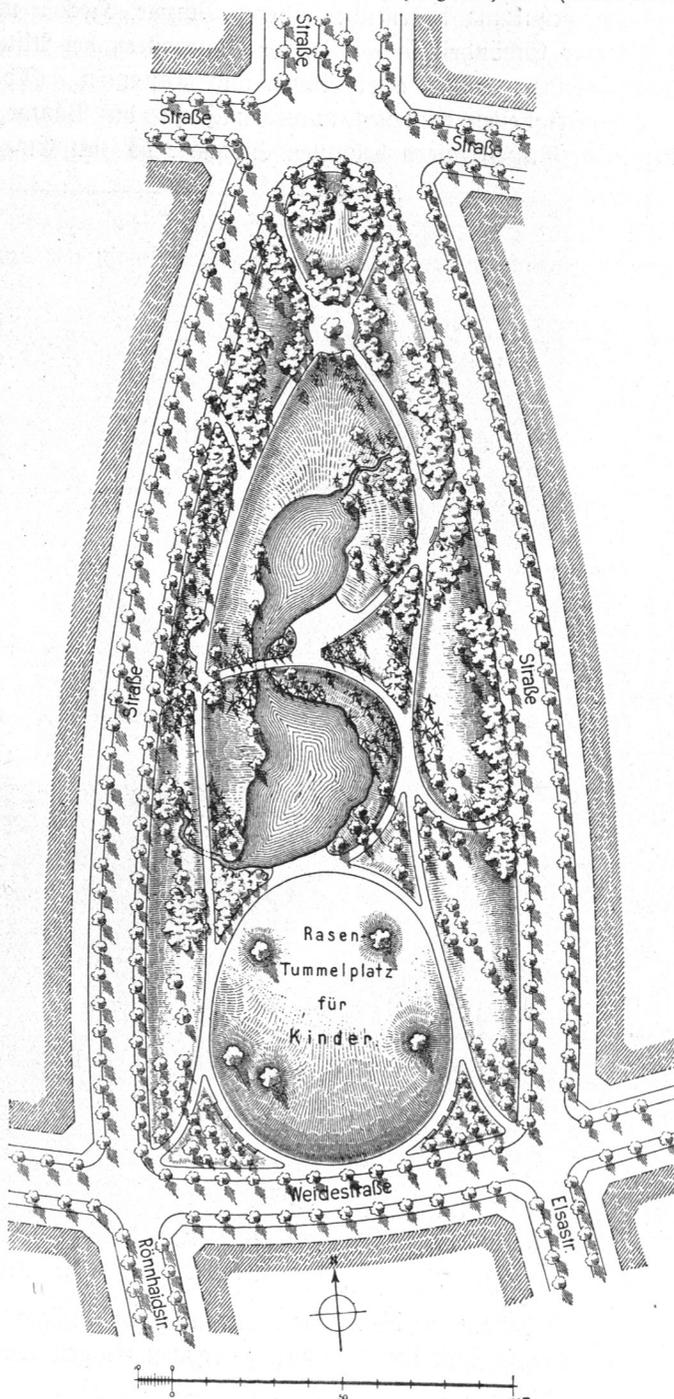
Grünanlage Schleidenplatz, Lageplan.
